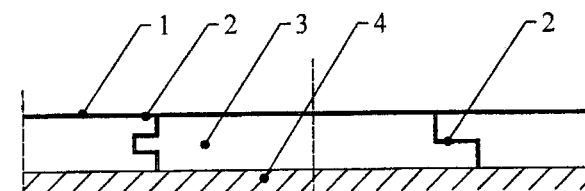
Pardoseli din parchet lamelar sau parchet cu lambă și uluc montate prin lipire cu adeziv pe dală flotantă
